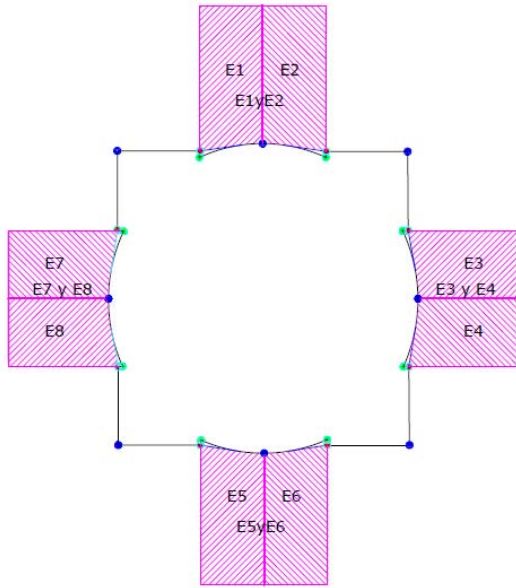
Aplicación de la metodología sobre el edificio a levantar. 2012. La Autora.
